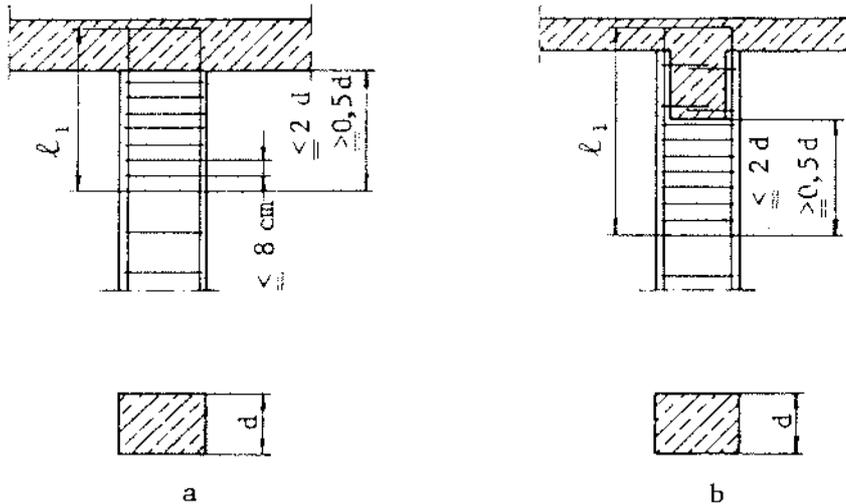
a y 56 b. Refuerzo de la armadura de estribos en la zona de anclaje de la armadura longitudinal.
